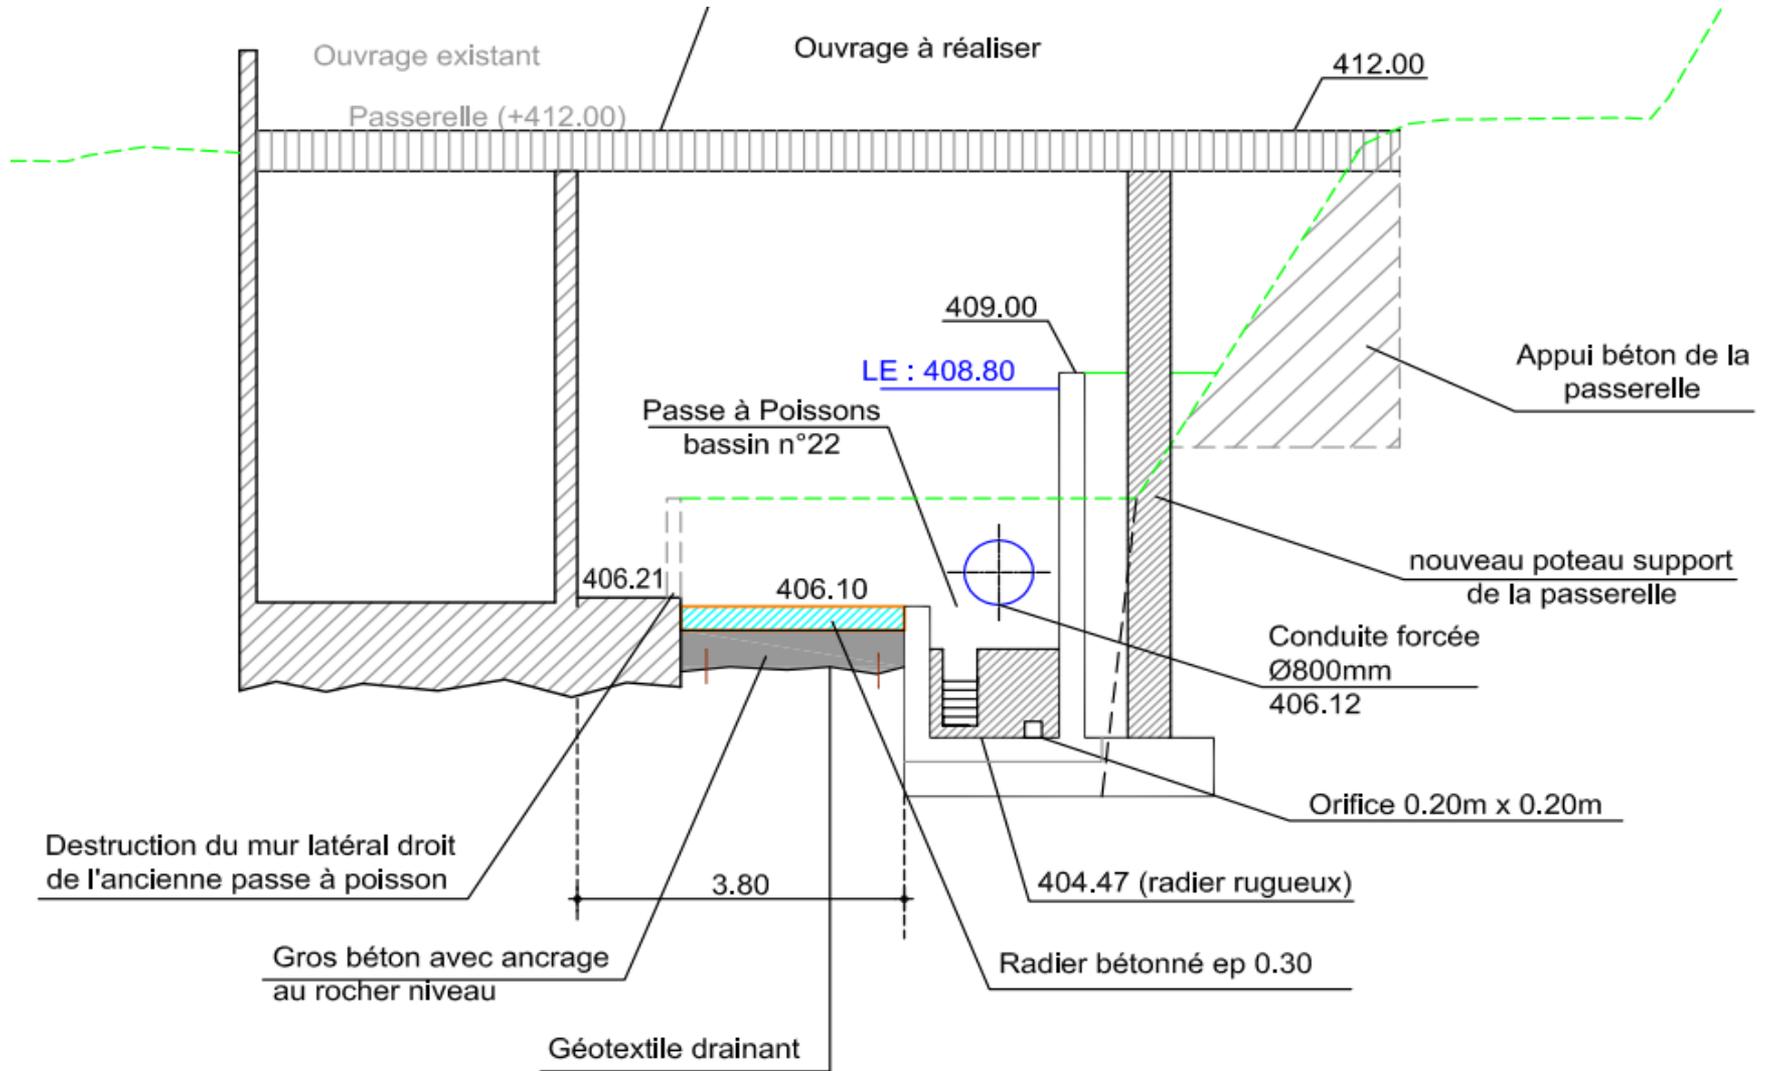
coupe BB au droit du chenal secondaire partie amont
